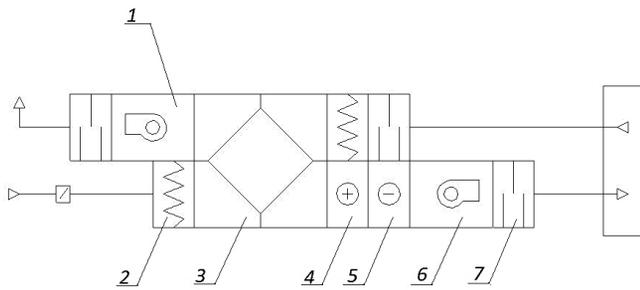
Принципиальная схема вентиляции с рекуператором: 1 — вытяжной вентилятор; 2 — воздушный фильтр грубой очистки; 3 — рекуператор; 4 — воздушонагреватель; 5 — воздухоохладитель; 6 — приточный вентилятор; 7 — шумоглушитель
